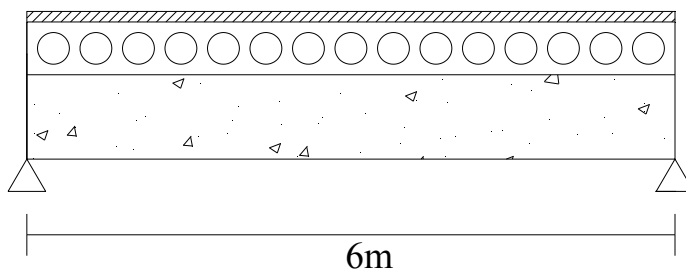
Seção longitudinal do modelo *viga em concreto armado composta*.
